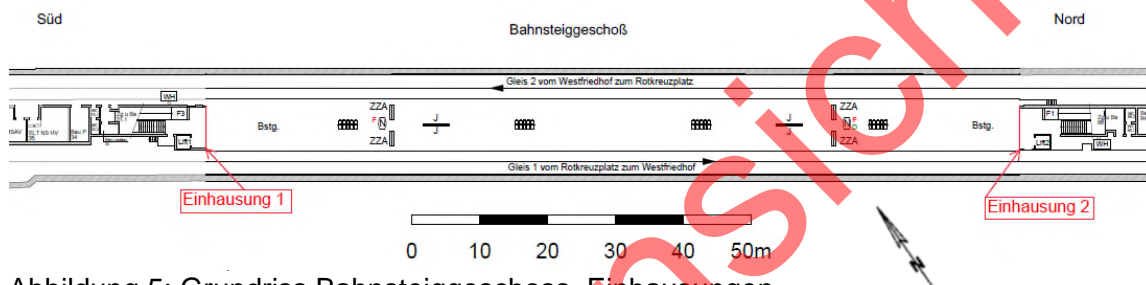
Grundriss Bahnsteiggeschoss, Einhausungen
